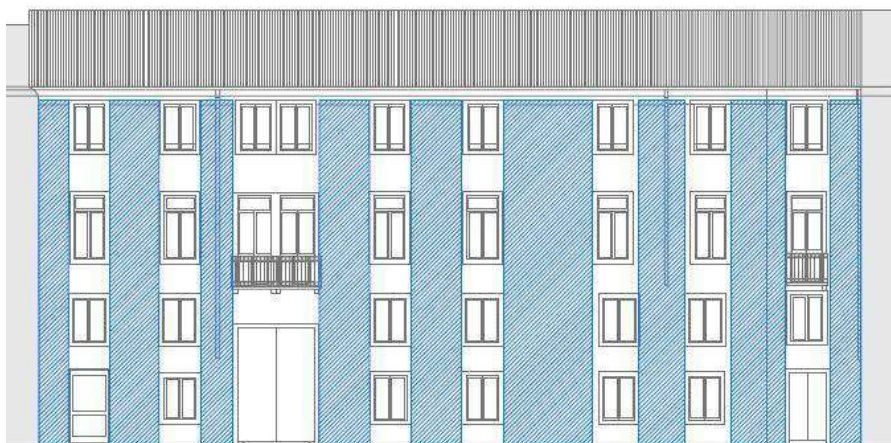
distribuzione aperture prospetto corpo ovest
